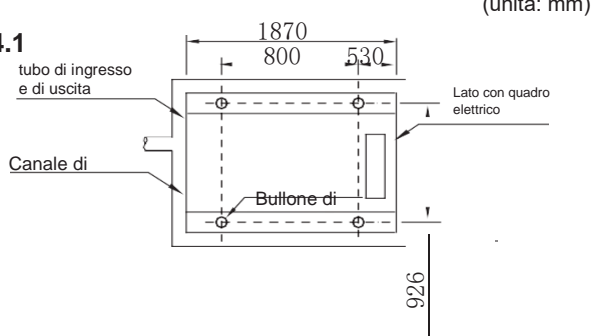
Vista dall'alto di un diagramma schematico delle dimensioni dell'installazione SCV-300EBH
